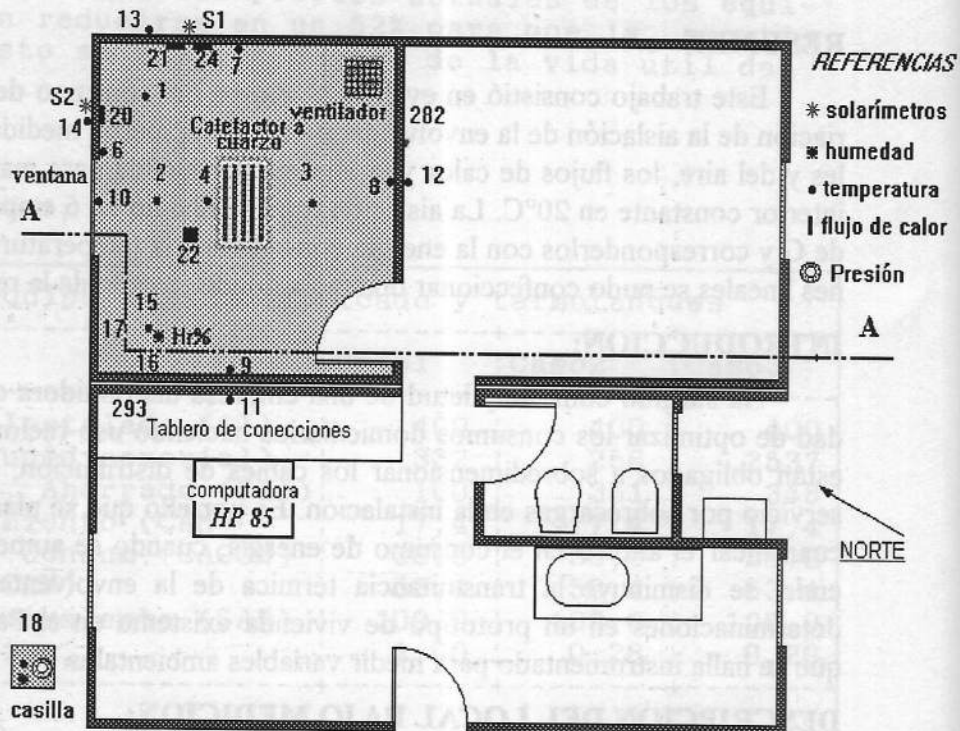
Vista en planta del prototipo de vivienda y ubicación de los sensores.
